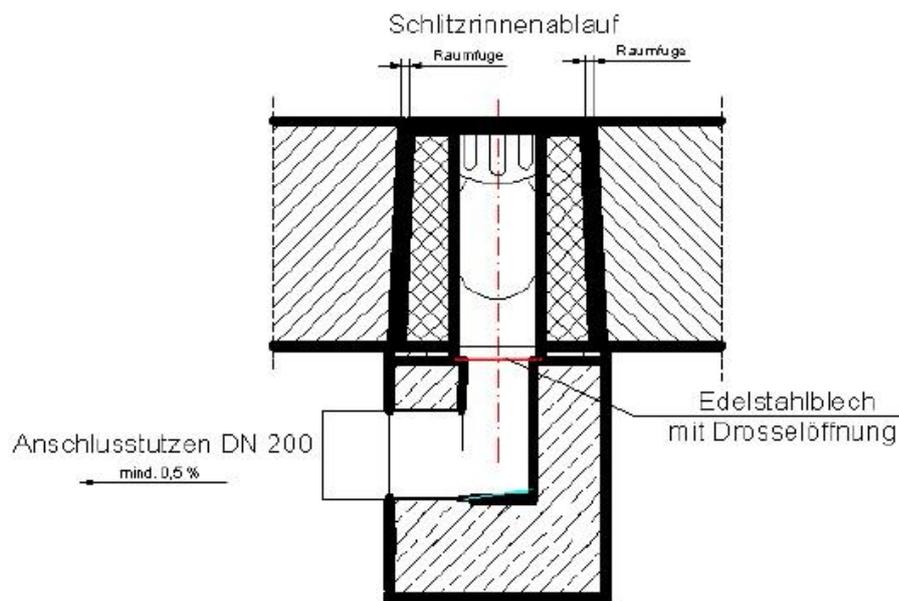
Querschnitt des Ablaufs mit Drosselblende [15]
